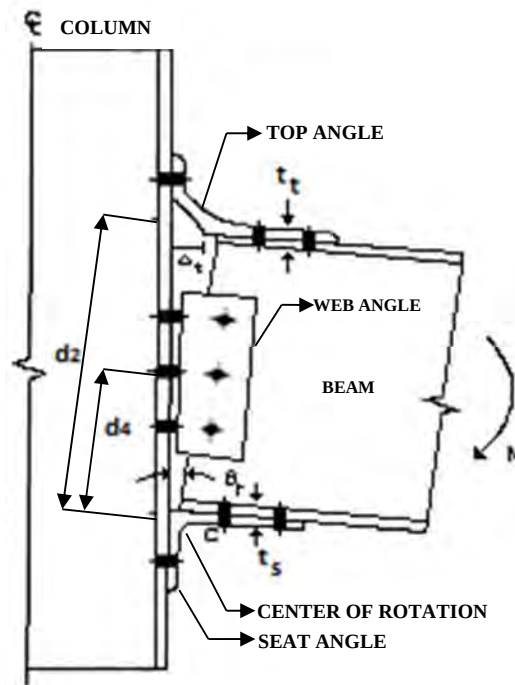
Deformación de una conexión viga-columna conformada por un perfil ángulo superior, un perfil ángulo inferior y doble ángulo en el alma (Kim & Chen, 1996)
